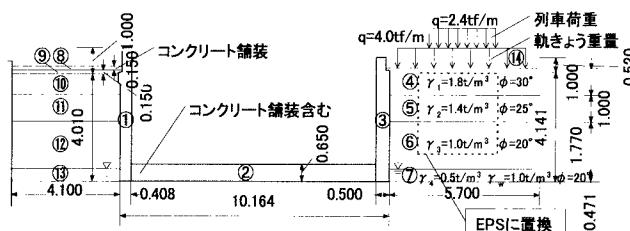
U字型擁壁断面図 D-D断面 (単位 m)
